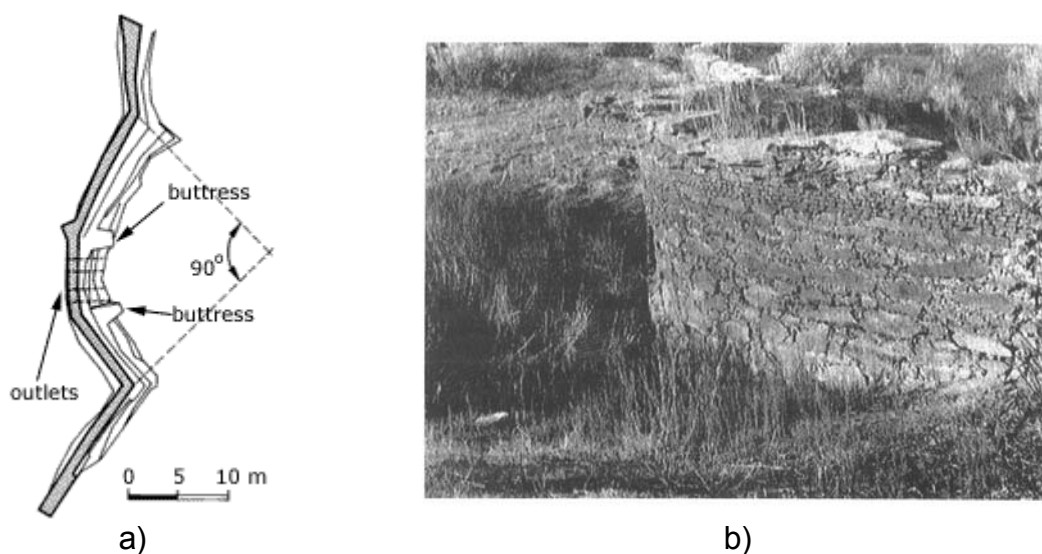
Barragem de alvenaria de Monte Novo (Portugal): a) planta [Schnitter, 1994], b) vista do paramento de montante [Quintela et al, 1986]
